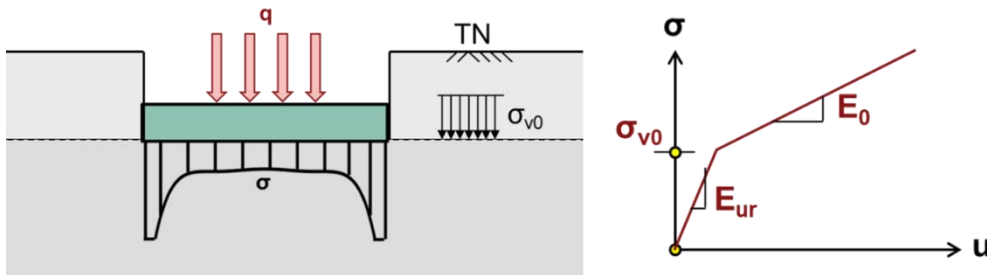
Traitement d'un radier fondé au fond d'une excavation
